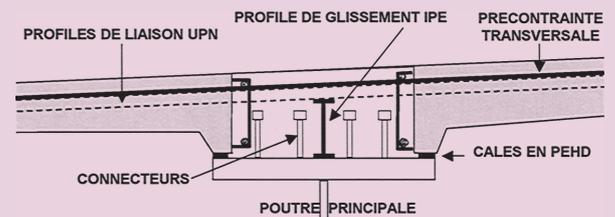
Modalités de liaison entre encorbellements et partie centrale en construction adoptées jusqu'en 2005
